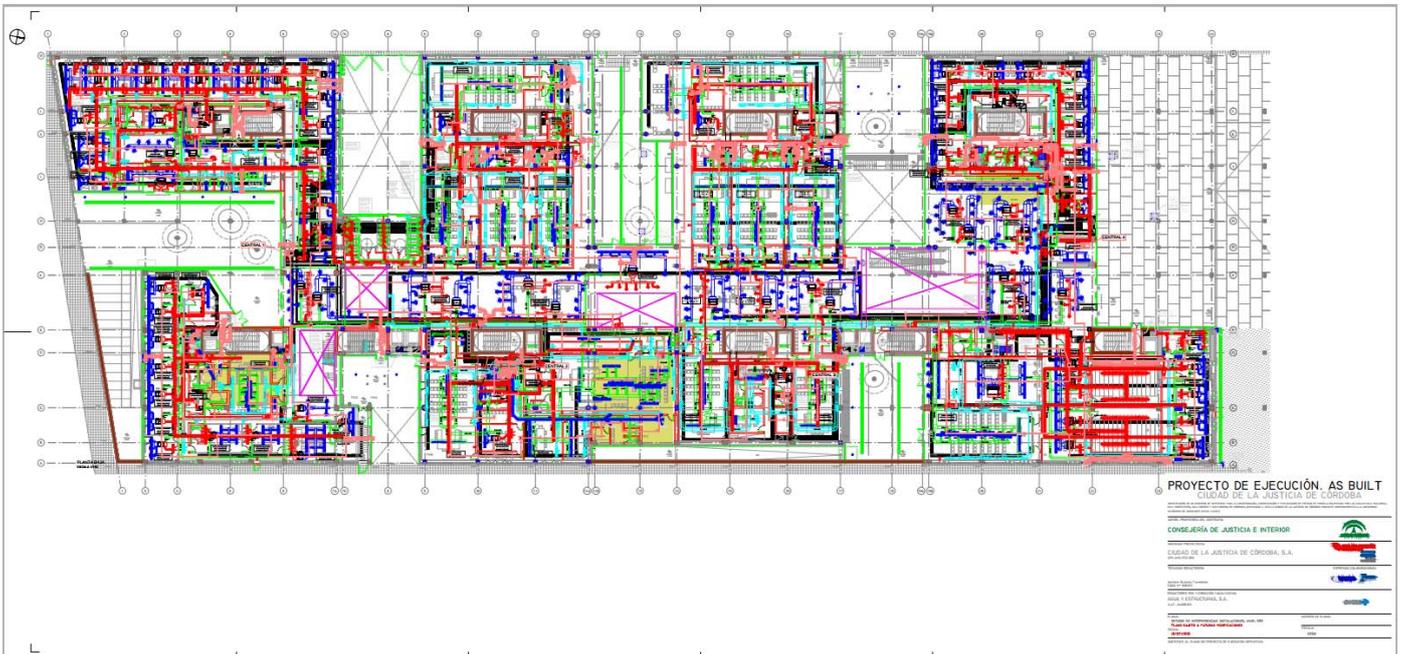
Plano de coordinación de las instalaciones MEP y arquitectura (planta baja, M1, M2, M3, M4).
